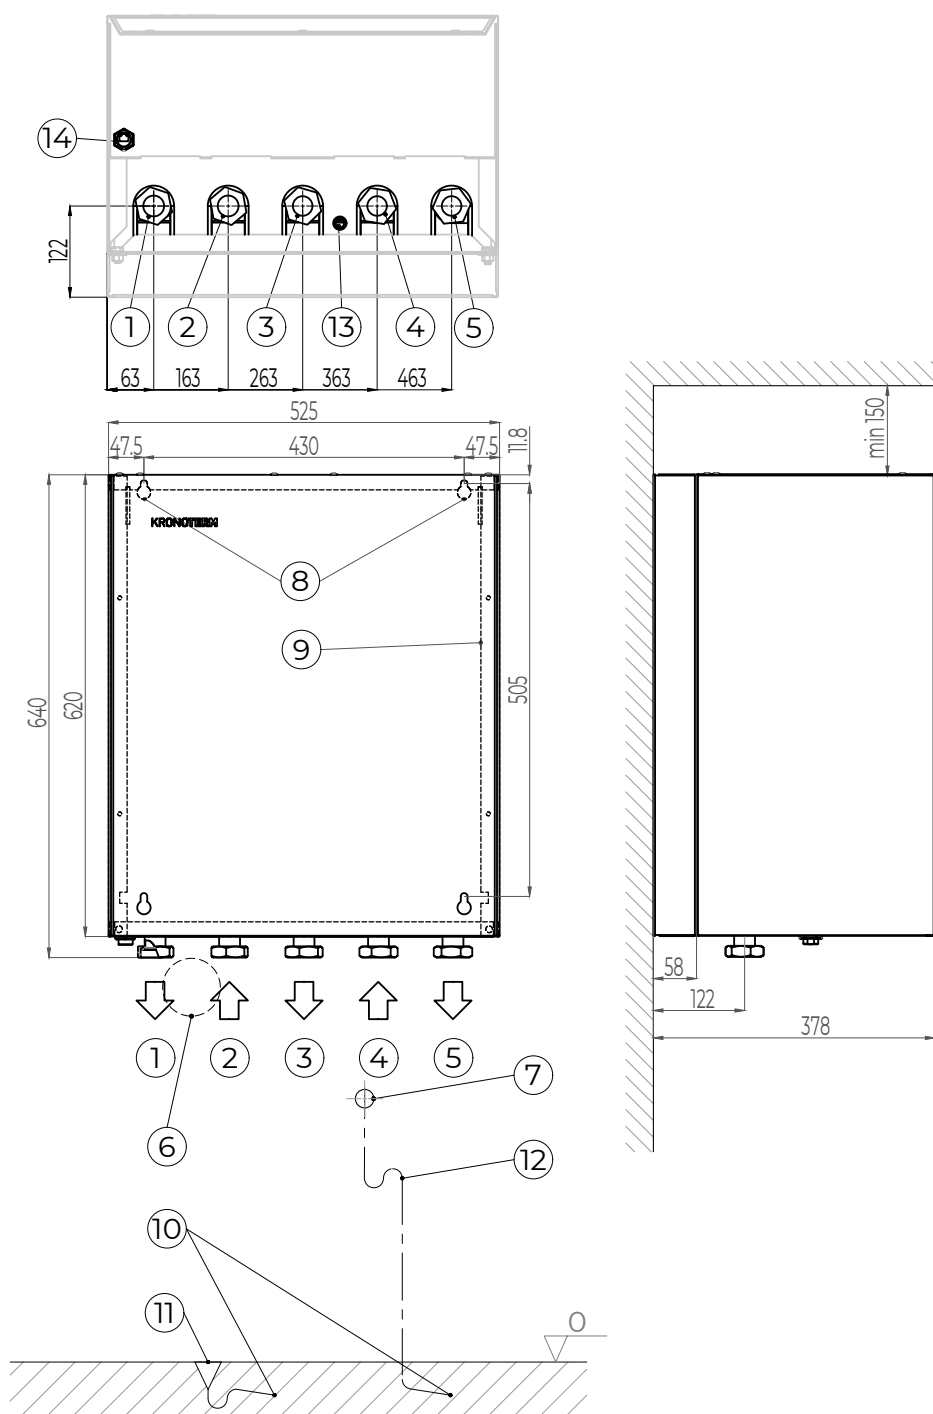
Bijlage 2 - Plan voor het gereedmaken van de HYDRO S2 voor installatie
